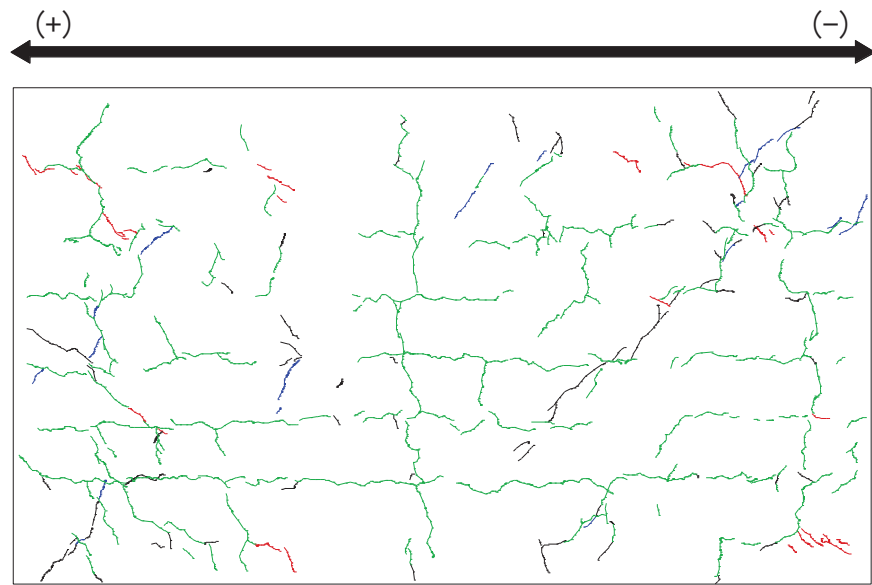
(5) 乾燥試験体 [2] 1/2500rad. におけるひび割れ図
